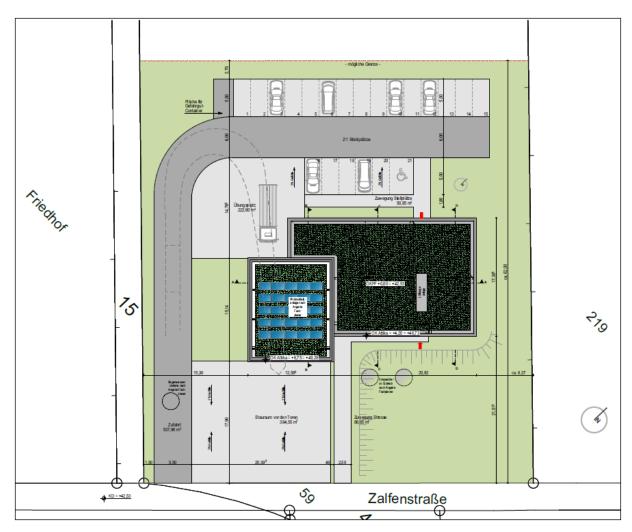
Städtebauliches Konzept, Lageplan; (Baues Architekten, 25.03.2022)
